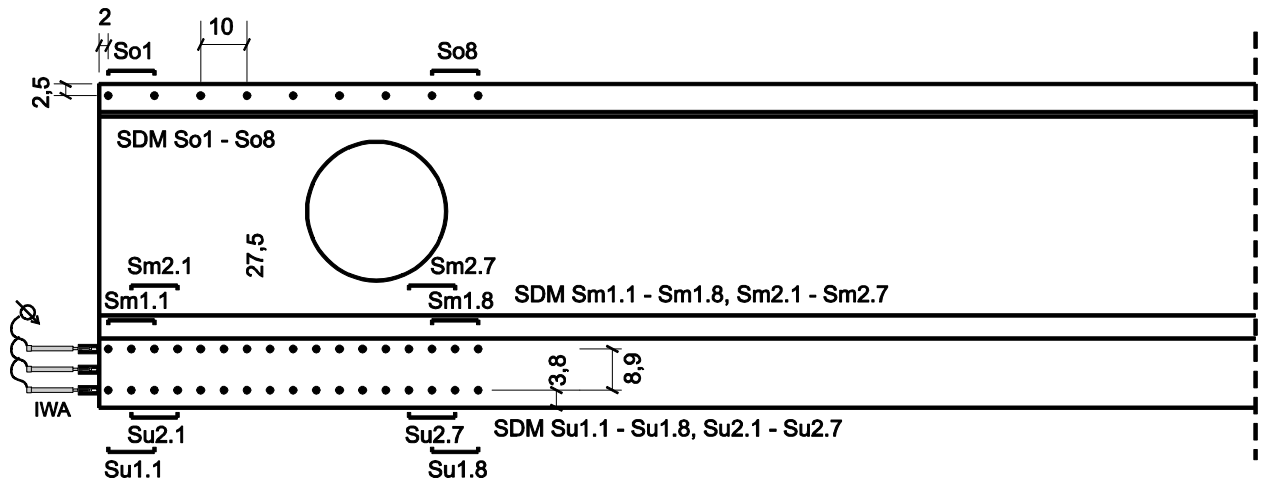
Messtechnik während der Spannkrafteinleitung exemplarisch für $h = 70$ cm
